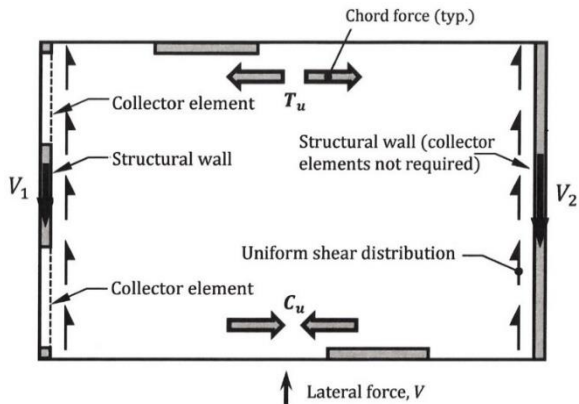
Tata Letak Shear Wall pada Bangunan
